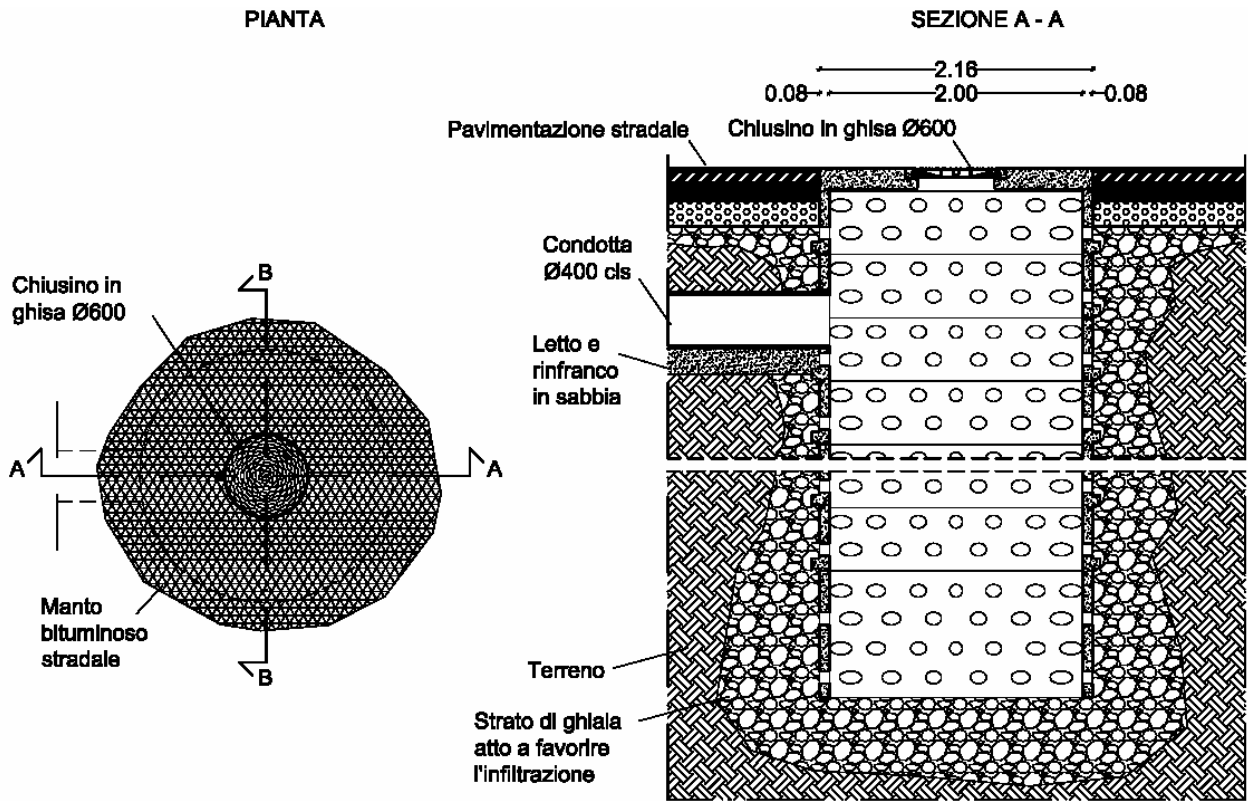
Particolare costruttivo del pozzetto drenante di diametro pari a 2,00 m.
